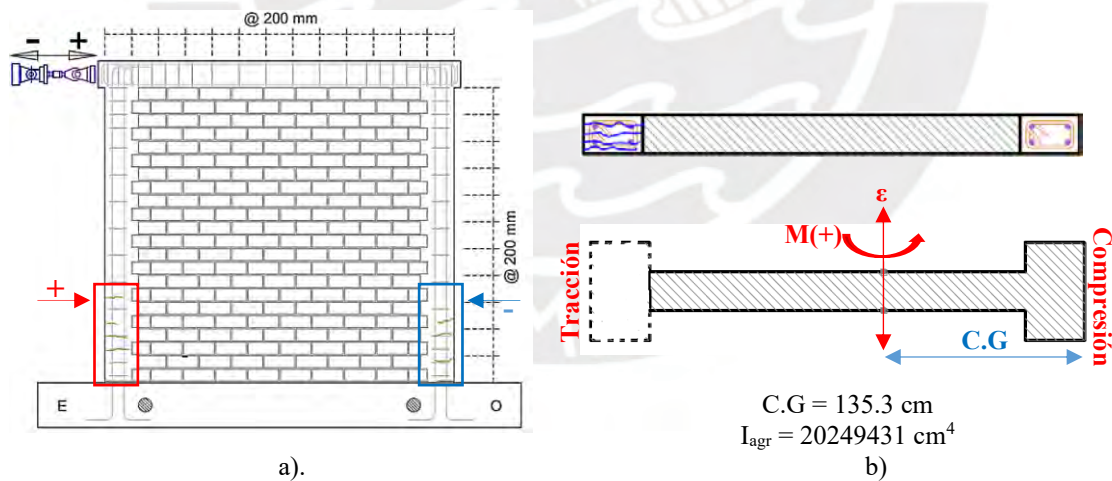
a) Patrón de daños en elevación Fase 3 [19], b) Sección agrietada por carga horizontal positiva (+)
